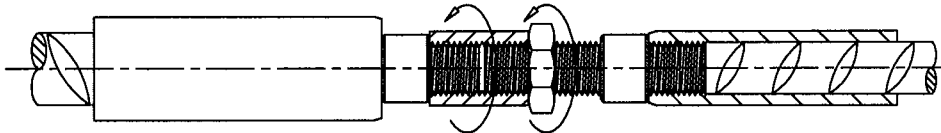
DISTANZÜBERBRÜCKENDE POSITIONSVERBINDUNG (PII)
